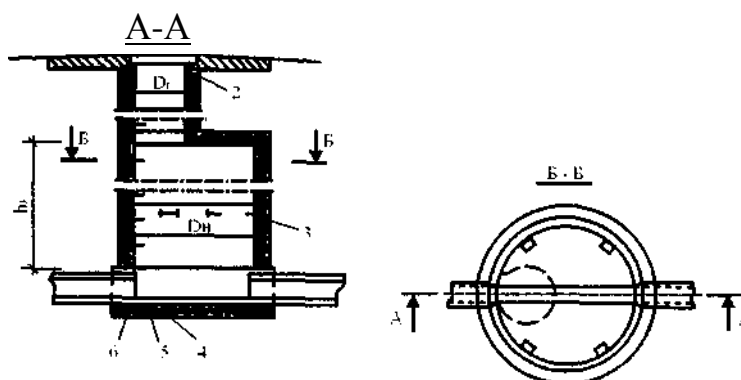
Смотровой колодец: 1 - люк с крышкой; 2 - железобетонные кольца горловины; 3 - то же, камеры; 4 - бетон М 200 с затиркой; 5 - плита основания; 6 - песчаная подготовка
